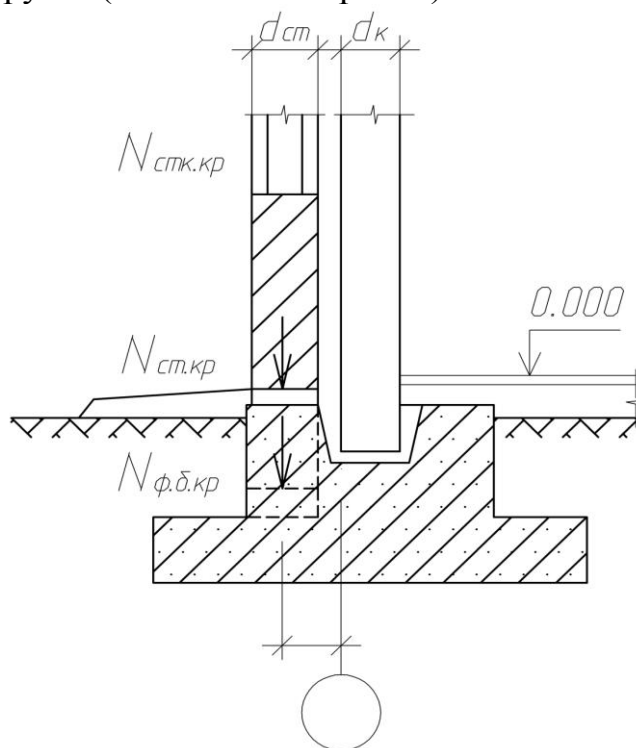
Схема для расчета момента от веса стенового ограждения, веса остекления и фундаментной балки
